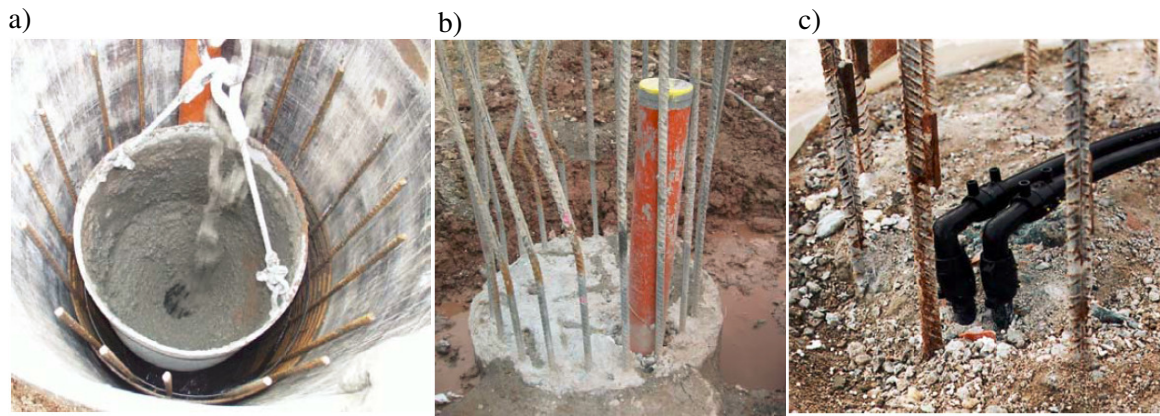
a) Betonieren des Bohrpfahls b) Anschluss Pfahlkopf c) Verbindung der Absorberleitungen zu den Anbindeleitungen [28]
